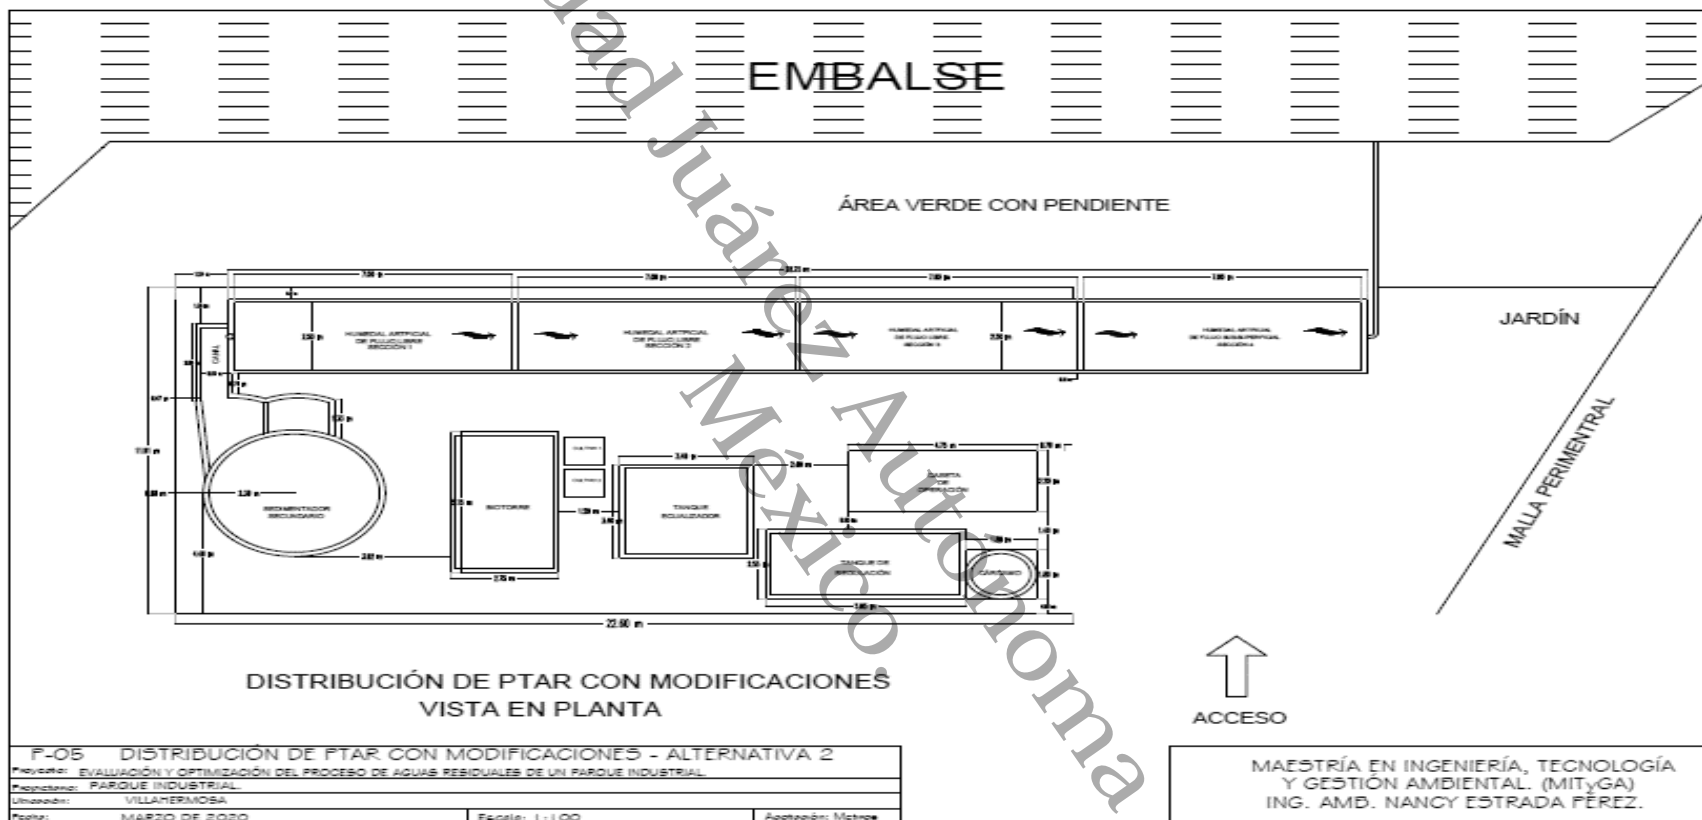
Distribución de la Planta con modificaciones (Vista en planta).
